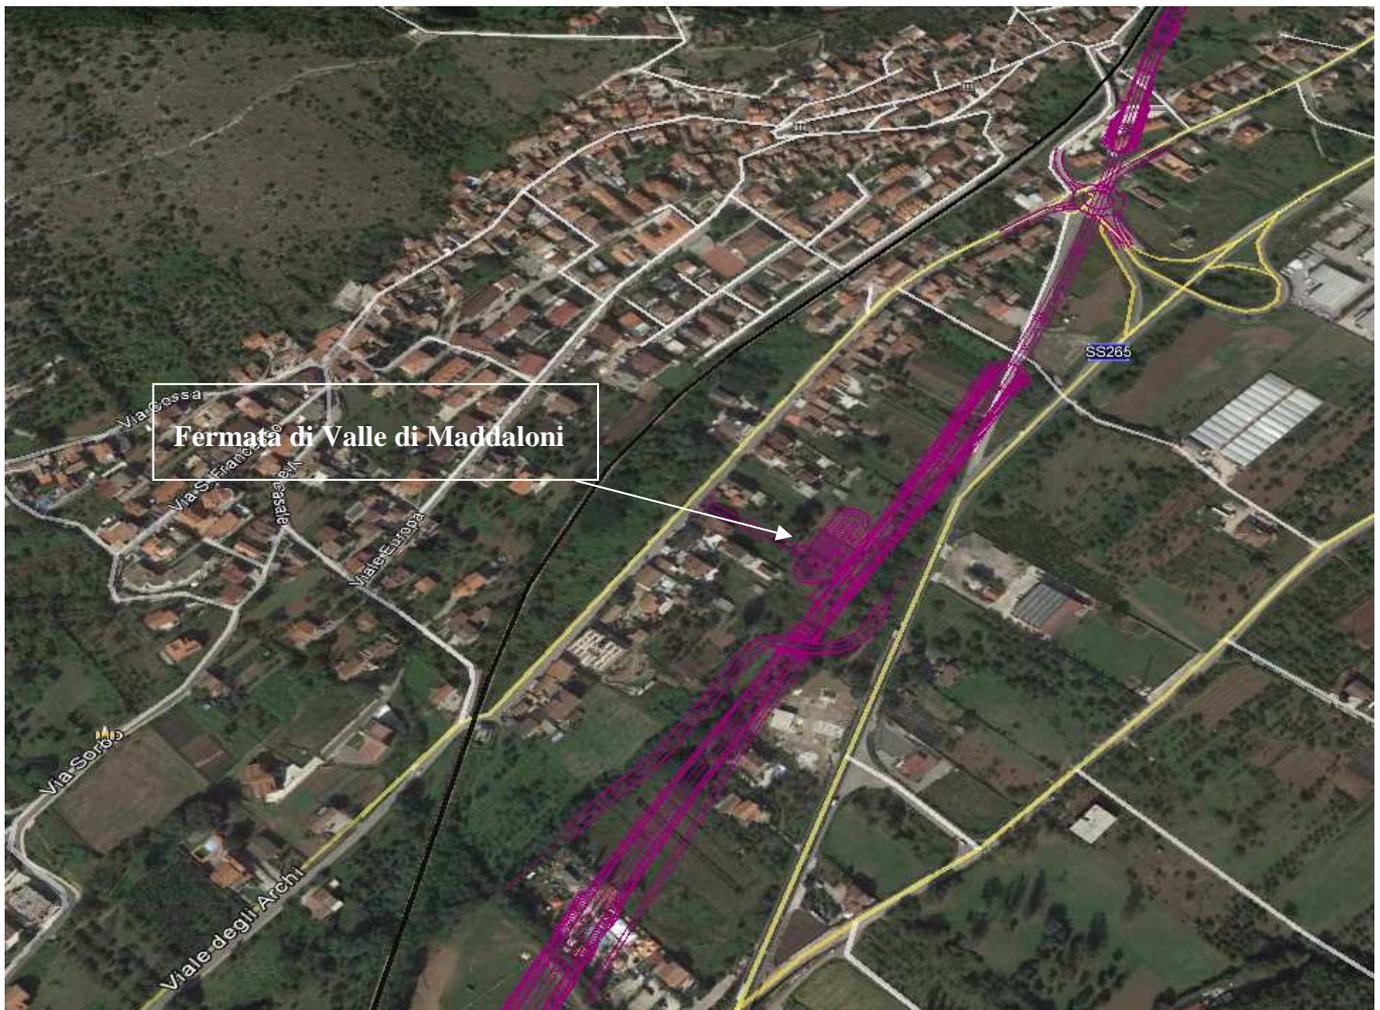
Individuazione delle aree di cantiere rispetto all'Acquedotto Carolino.
